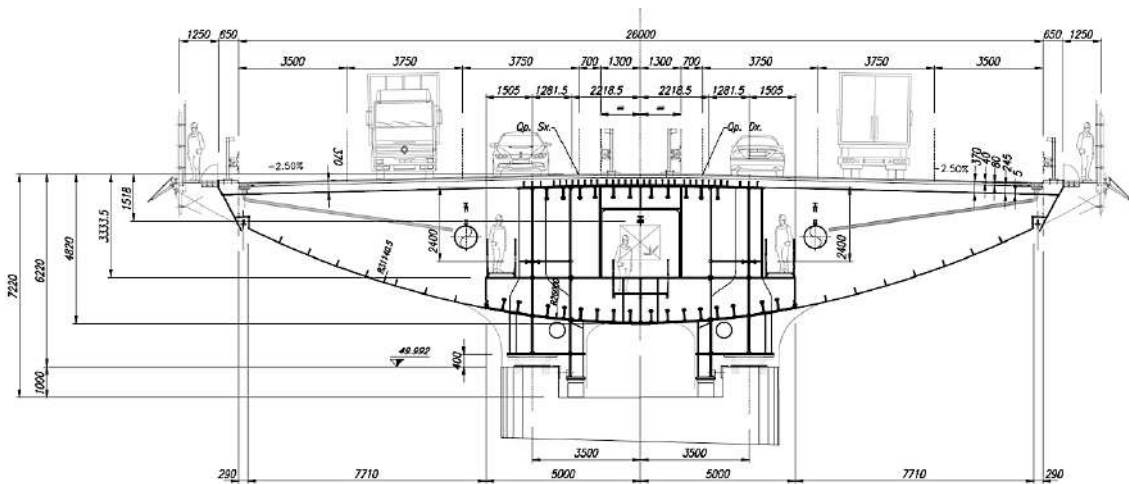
Seção transversal do tabuleiro na altura do Pilar 10. Fonte: ITALFERR
